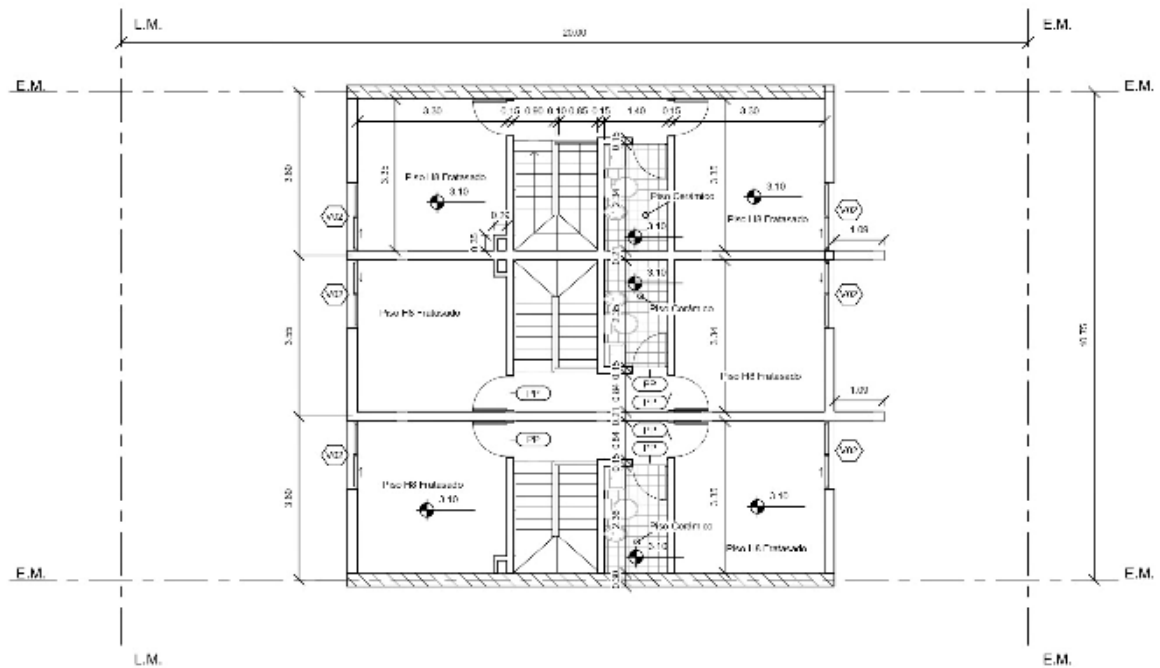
Planta Alta Dúplex prototipo DU 3.6 M
